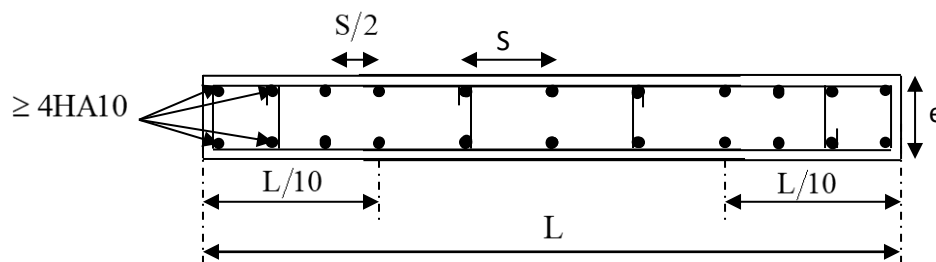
Disposition des armatures verticales dans les voiles.
